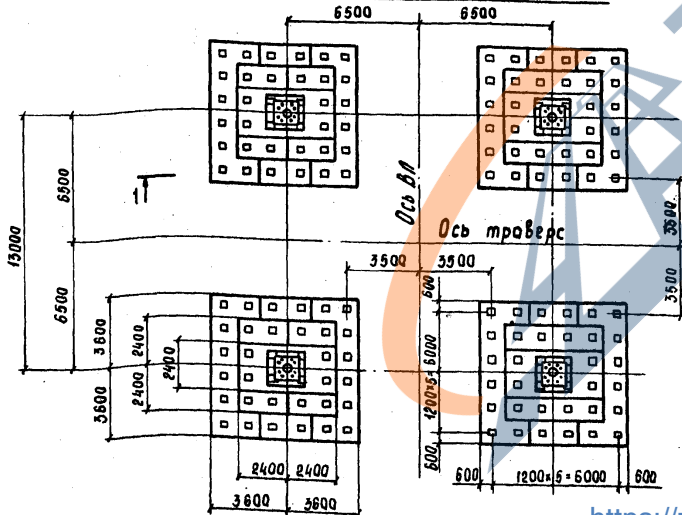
Отдельные ваки под каждую ногу опоры. Вариант фундамента со сборными плитами в основании.
